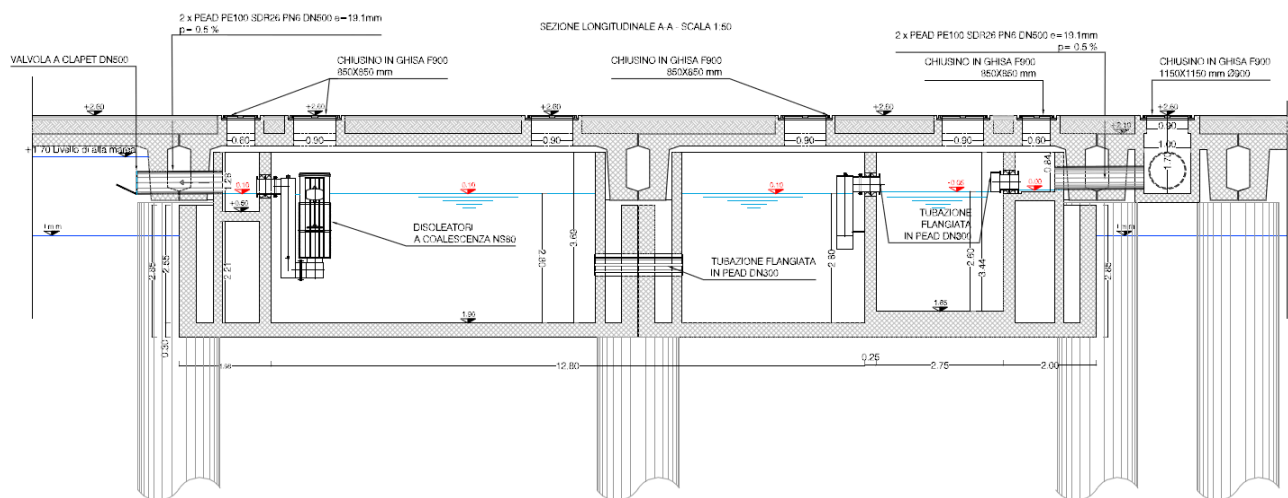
Sezione A-A dell'impianto di trattamento installato in piastre speciali
